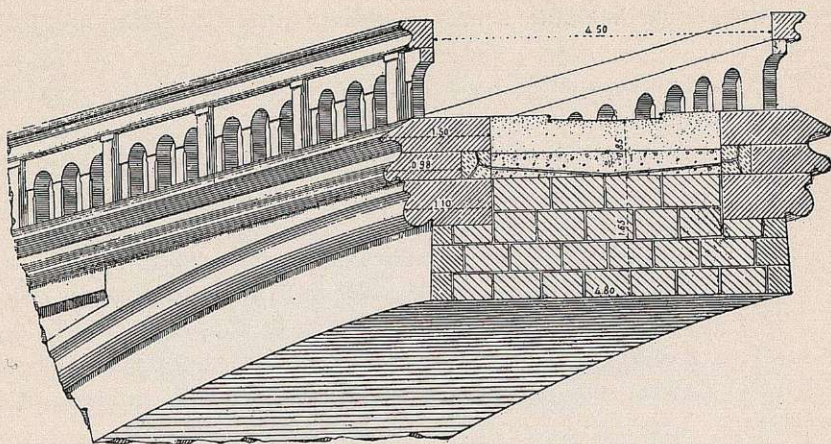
Sección por la clave y detalles del puente de Lavaur.
